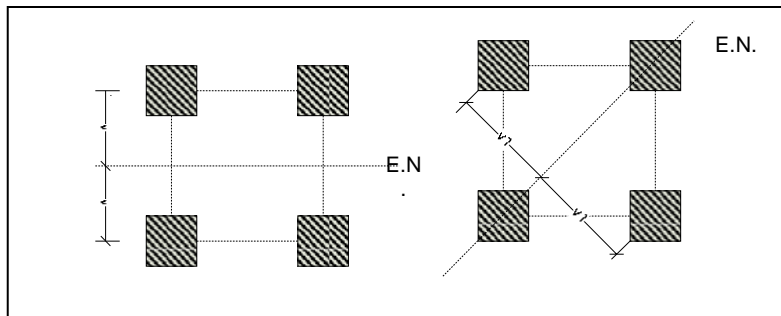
Fuerzas en las Columnas del Reservoirio Elevado
